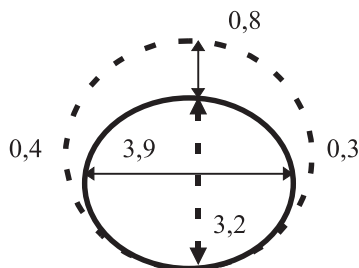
Profil jurty. ■ Section of a yurt. ■
